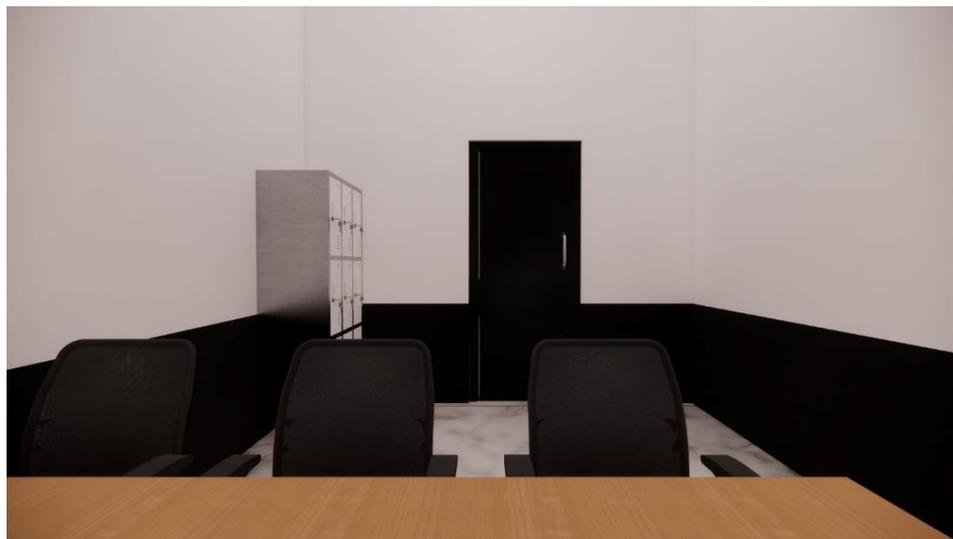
Ruang Tunggu Pasien Khusus Kursi Roda
